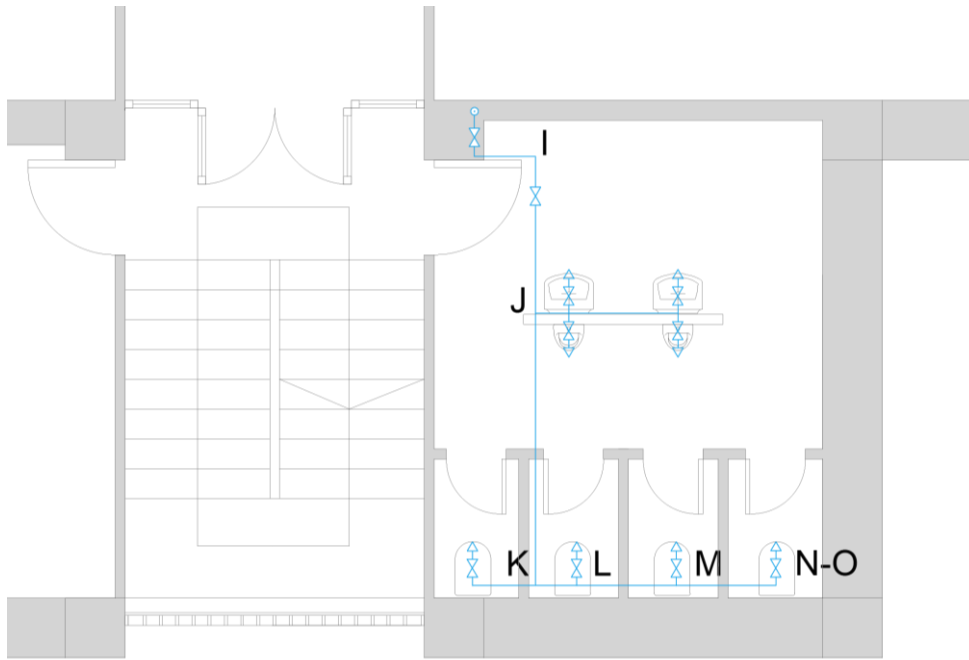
Planta baño chicos tipo 2 ala Sur
